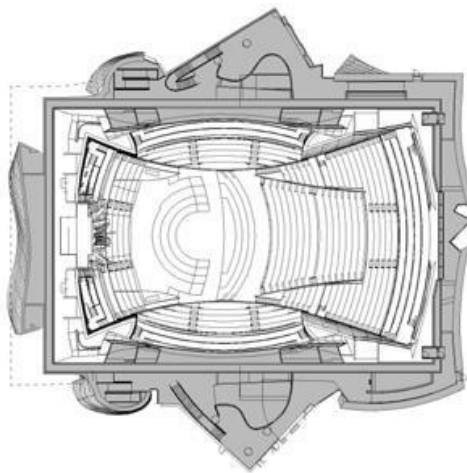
Planta da sala de concertos da Walt Disney Concert Hall.
